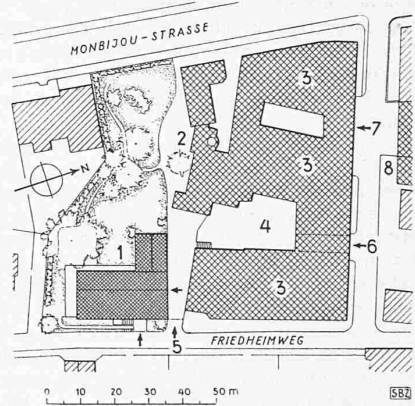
Lageplan 1 : 2000. — 1 Wohlfahrts-haus, 2 Velos, 3 Fabrik, 4 Hof, 5 Arbeiter-eingang, 6 Fuhrwerke, 7 Bureaueingang, 8 Garagen
